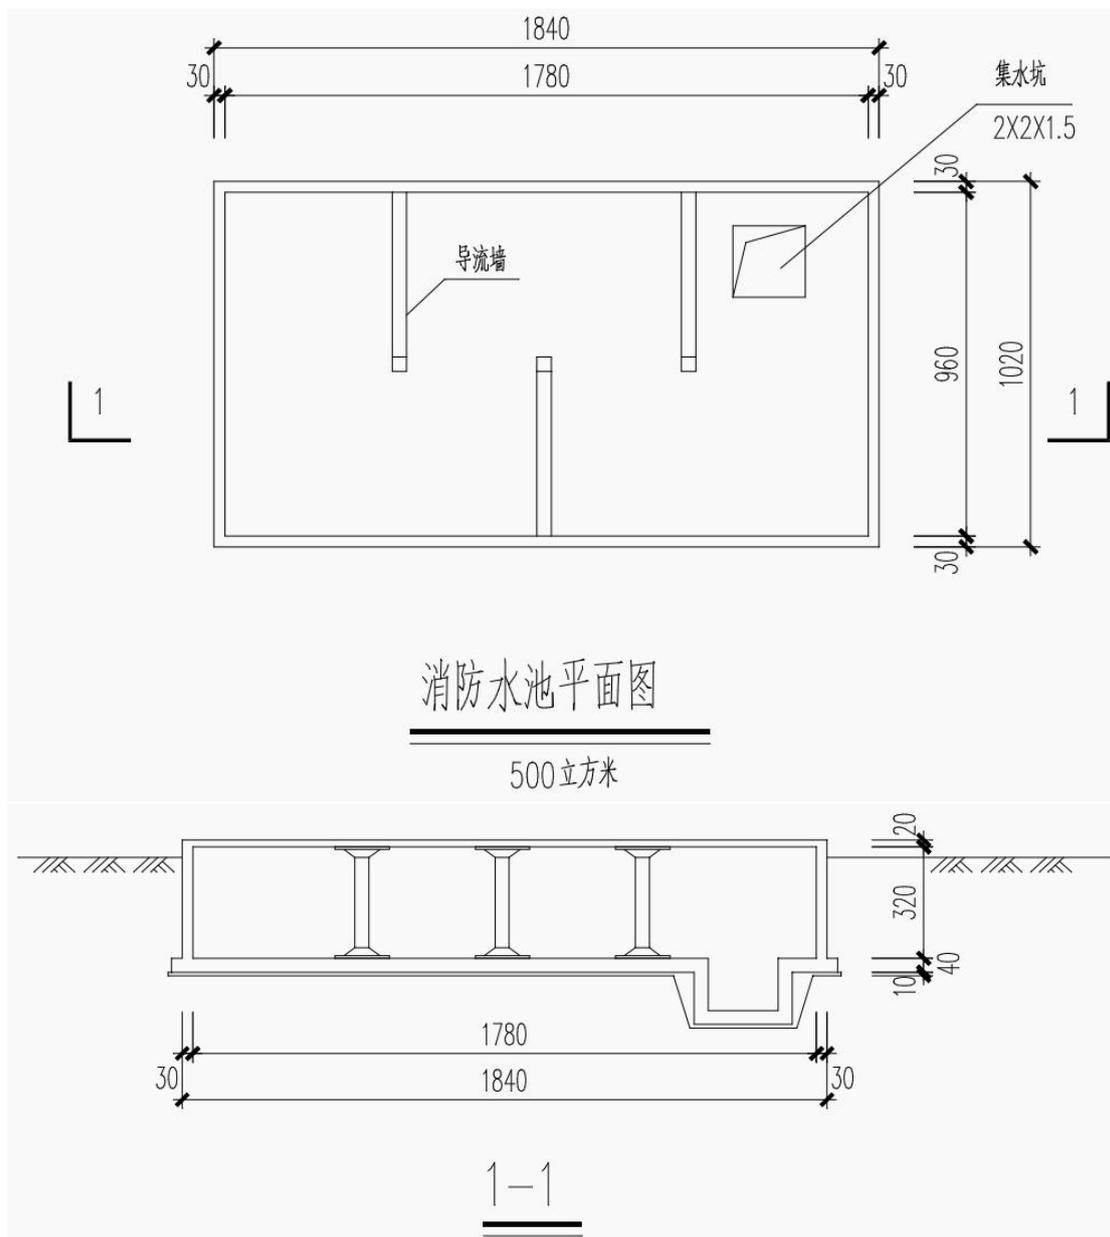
茂县 1#隧道消防水池平面布置图及剖面图
